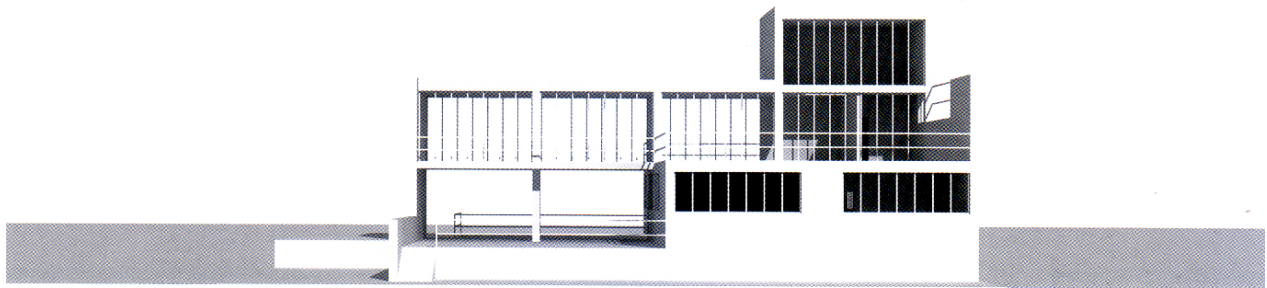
Progetto di casa Wilinsky, prospetto (disegno di M. R. Unterfrauner).
